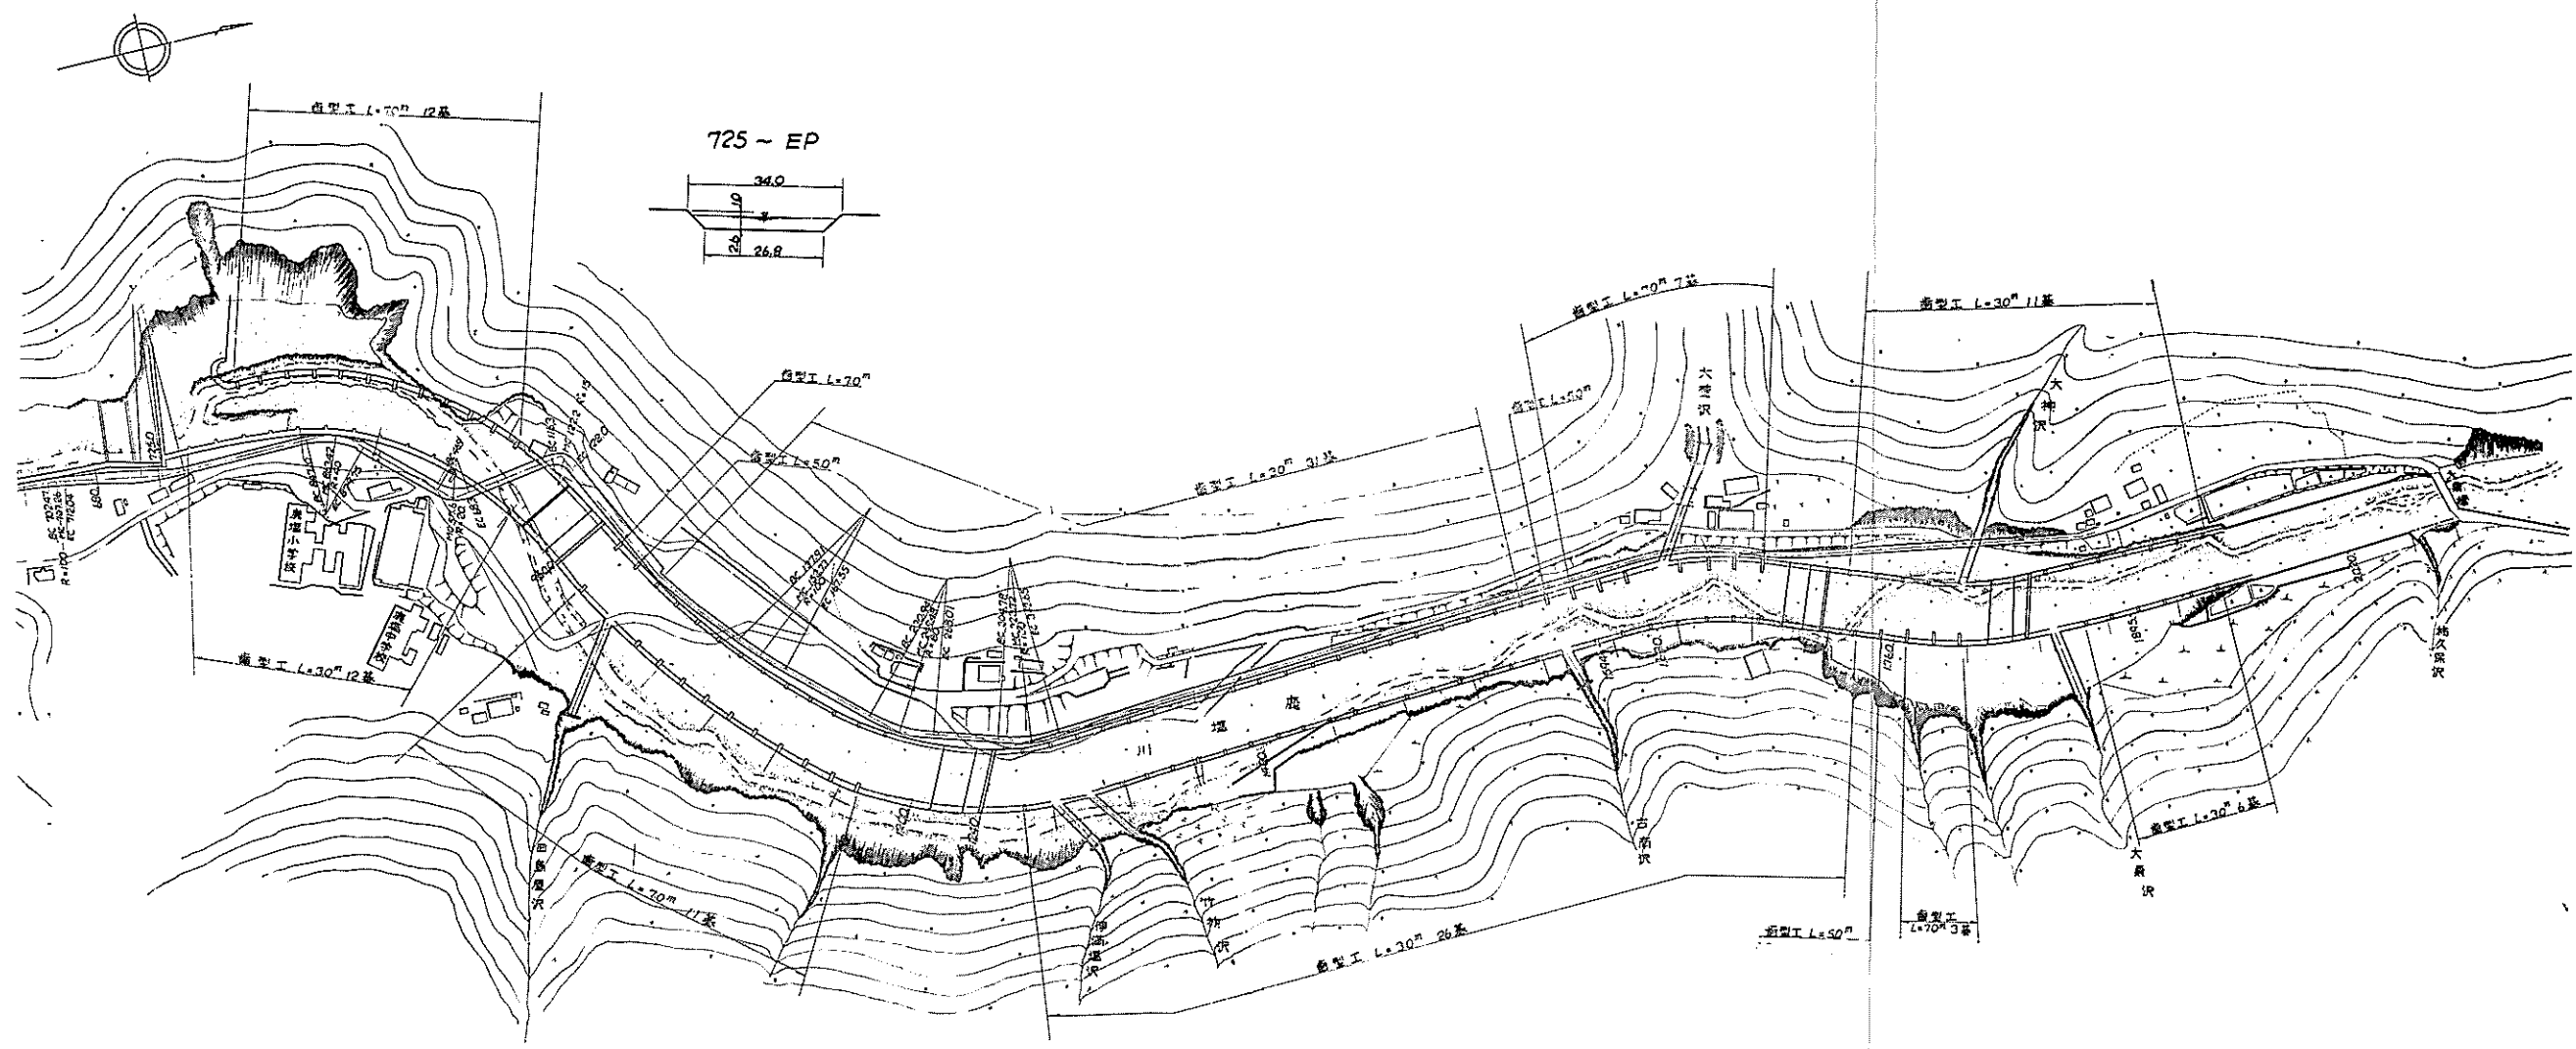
鹿塩川平面图 縮尺 1/4,000 (3)
